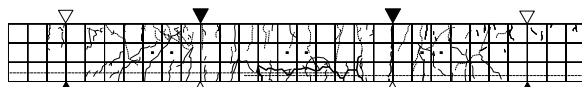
乾燥収縮ひび割れの発生状況 (側面)
